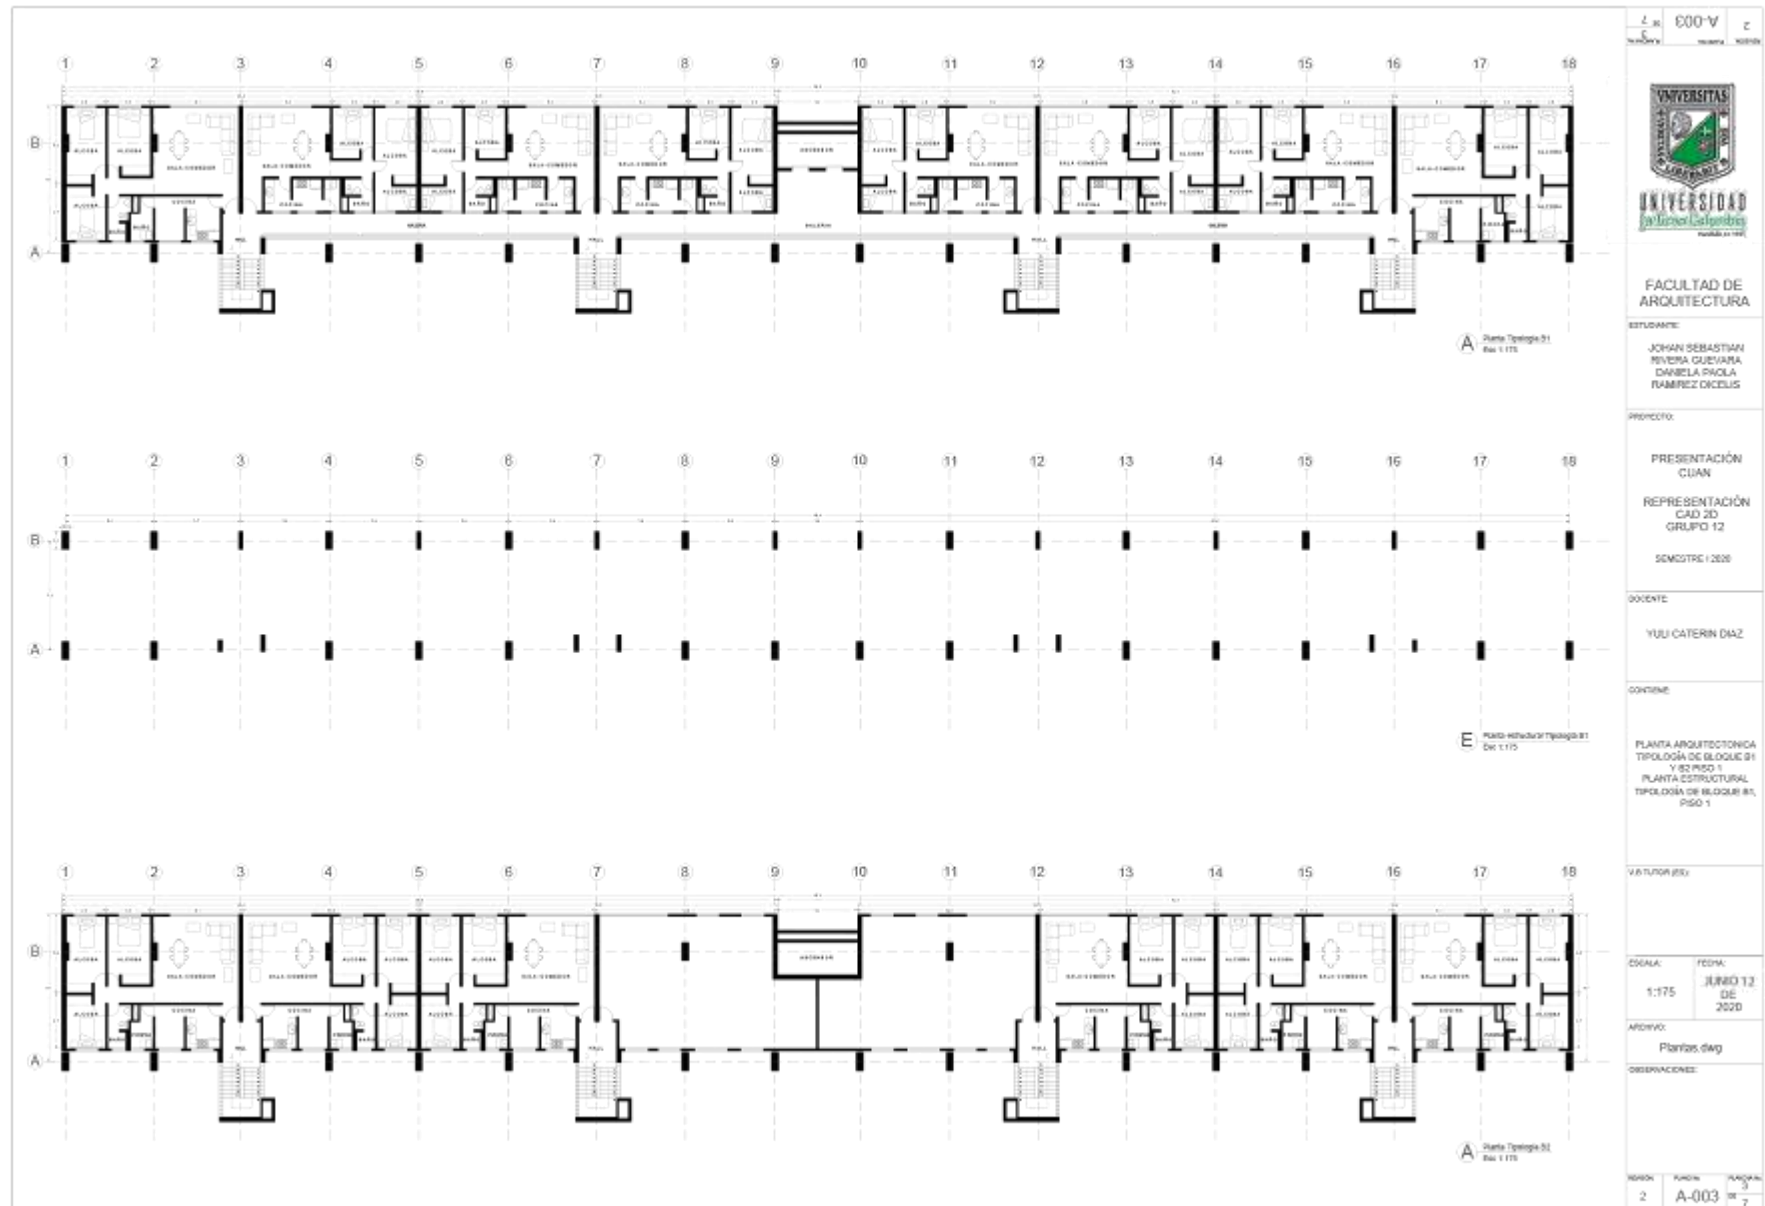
, Planta arquitectónica y estructural bloque Tipología B. Elaboración propia
